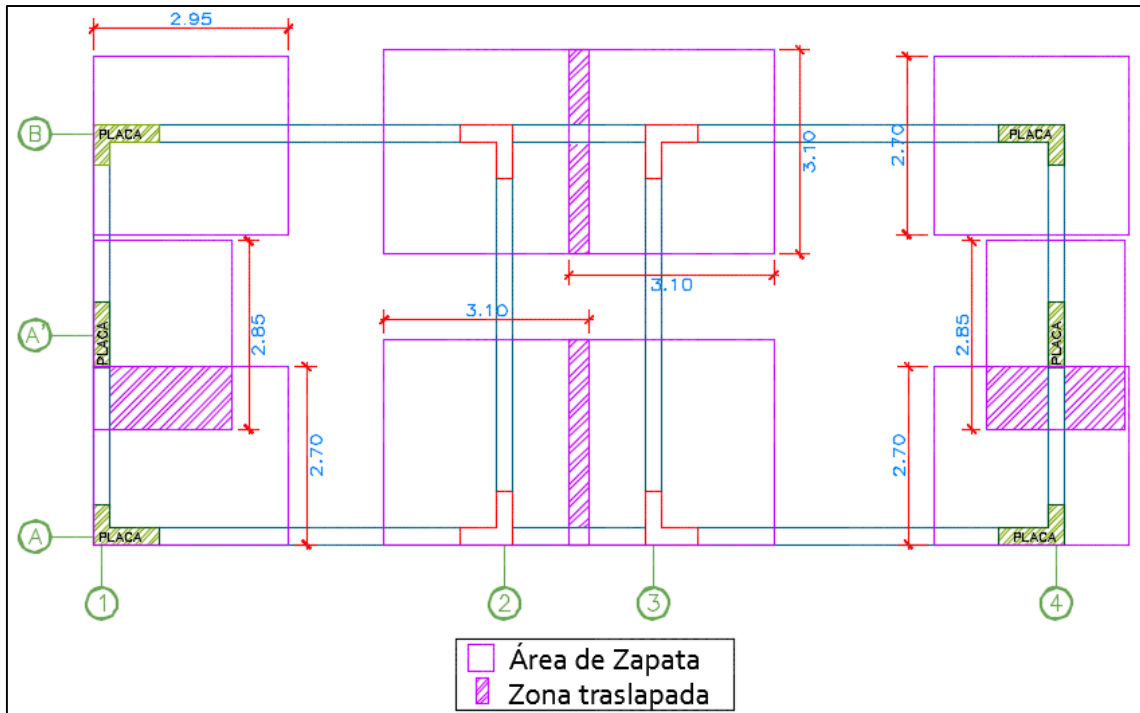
Área de contacto zapata aislada - Sistema dual tipo II
